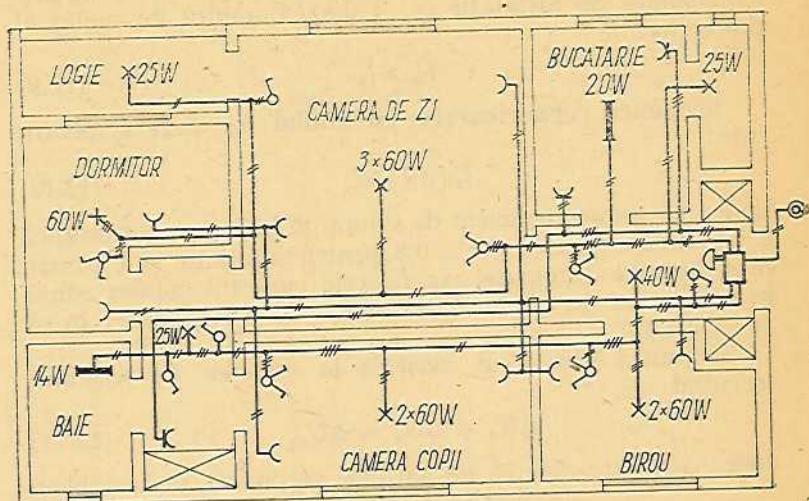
Planul și schema instalației electrice de iluminat și prize ale unui apartament.
